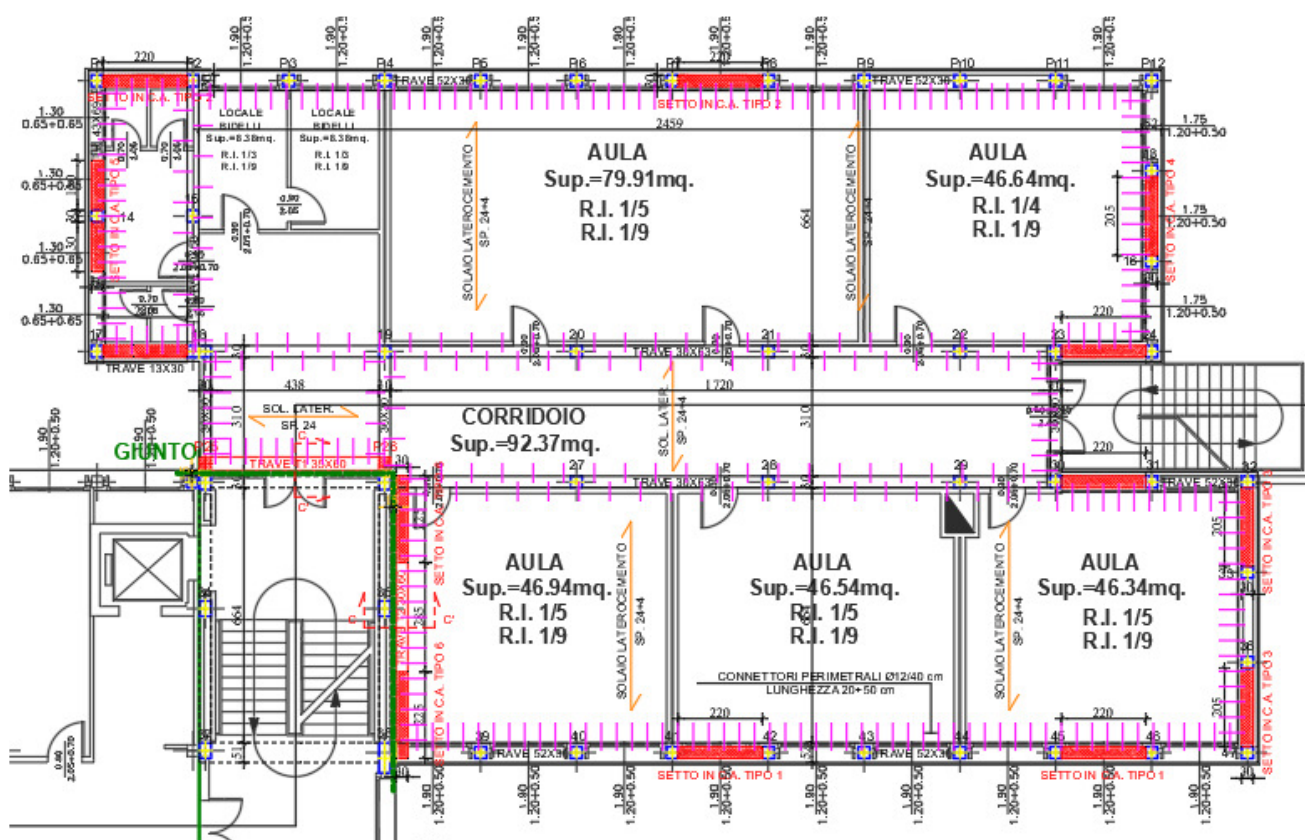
Lavori strutturali LOTTO 1 – piano primo
